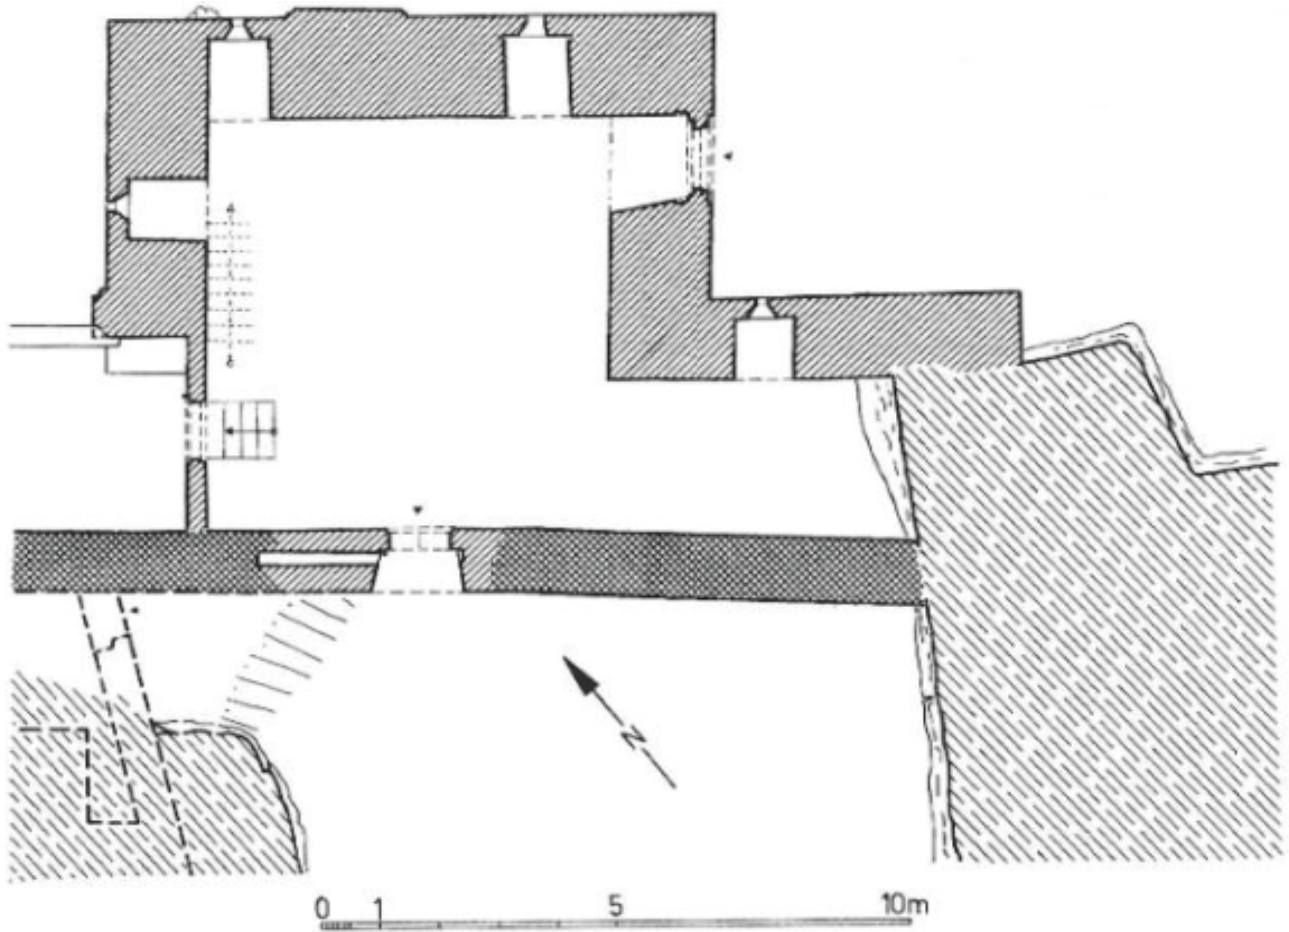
Grundriss der Streichwehr „Kühler Grund“ am östlichen Ende nach Daniel Burger, 2005
